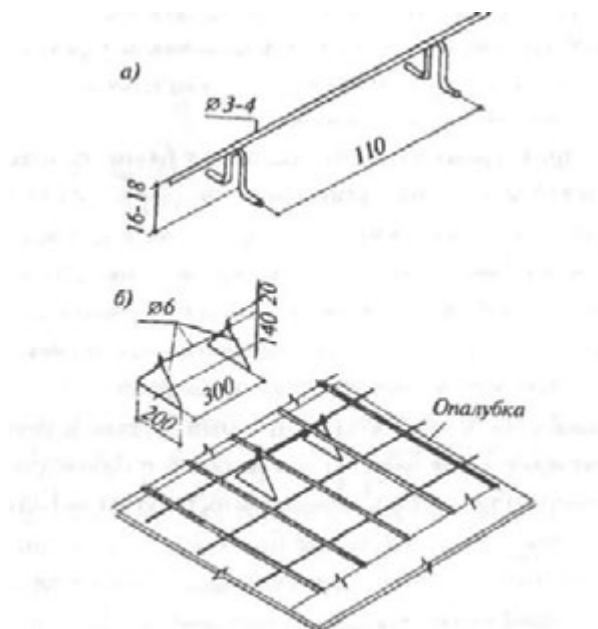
«Жаба» і «козелок» для забезпечення захисного шару бетону у перекриттях: *а* – «жаба», для забезпечення захисного шару для нижньої арматурної сітки; *б* – «козелки», для забезпечення захисного шару для верхньої арматурної сітки.
